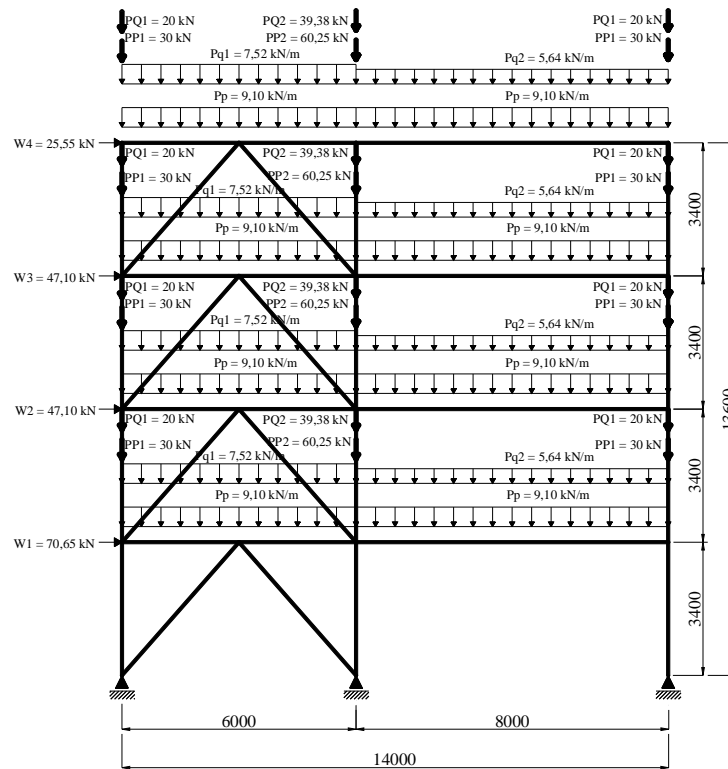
Pórtico contraventado de quatro pavimentos (dimensões em milímetros e ações com valores característicos)
